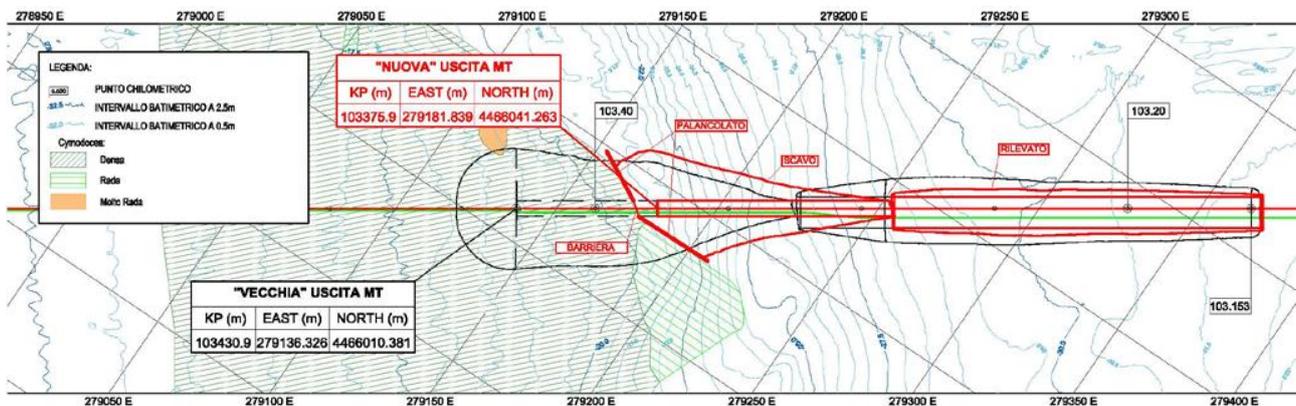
Vista dall'alto dell'area di dragaggio del MT (lato mare)
